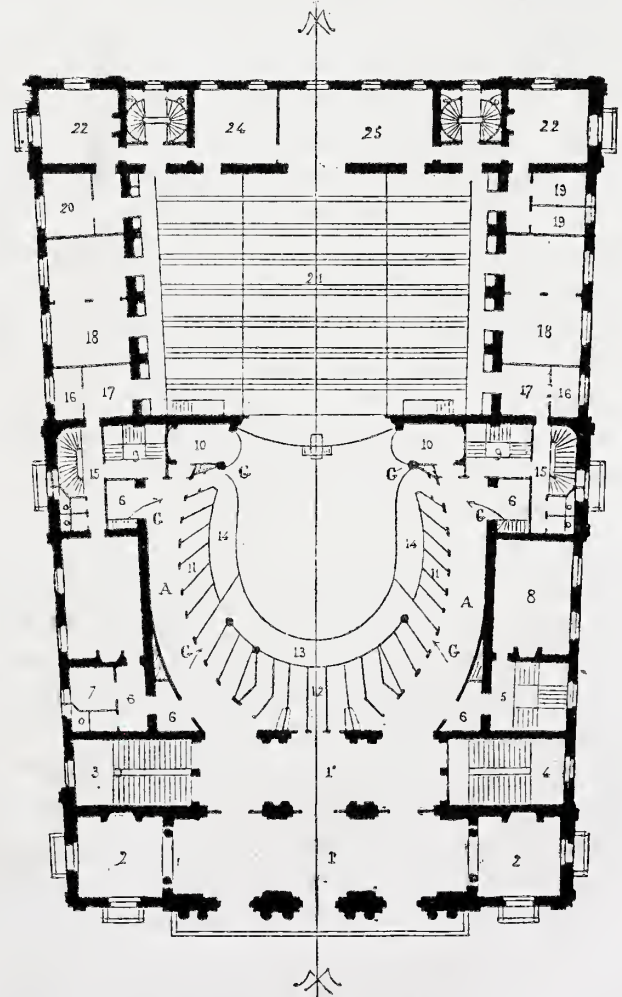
Plan du premier étage (Échelle de 0,002 p. m.).
